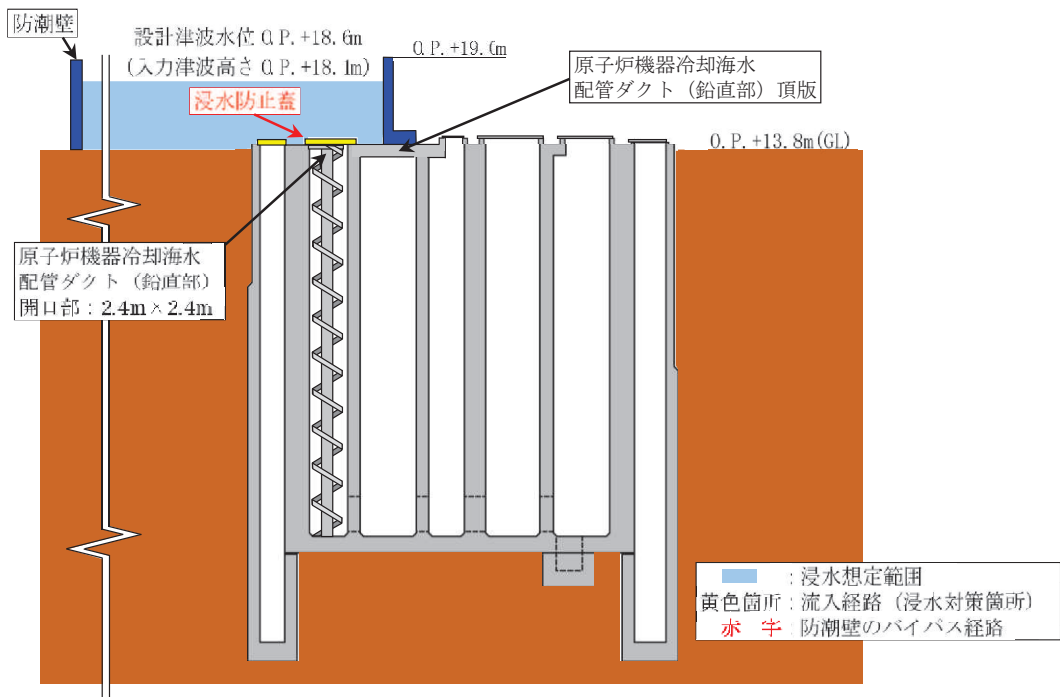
(2) 第 2 号機 海水ポンプ室 流入対策配置図 (B-B 断面図)
